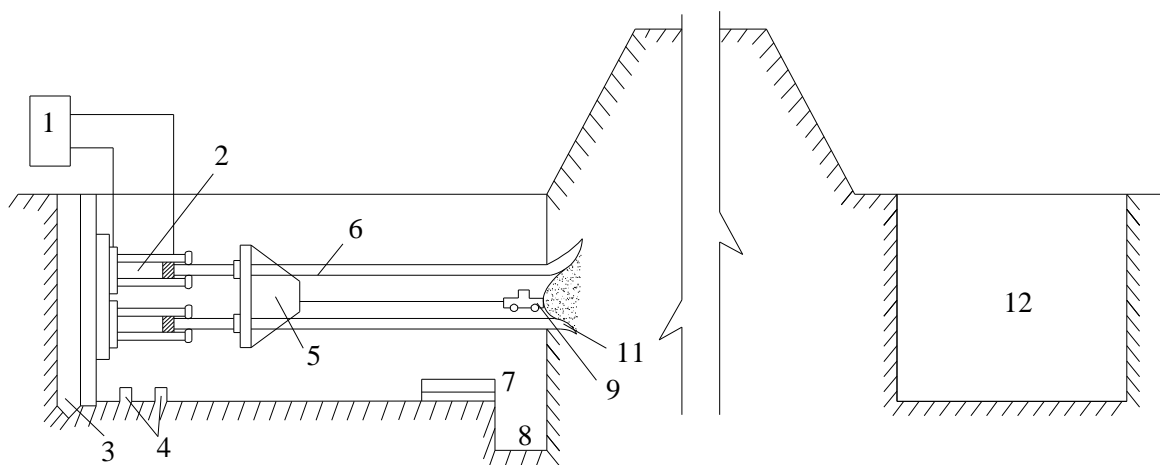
Схема безтраншейной прокладки газопровода методом продавливания:
